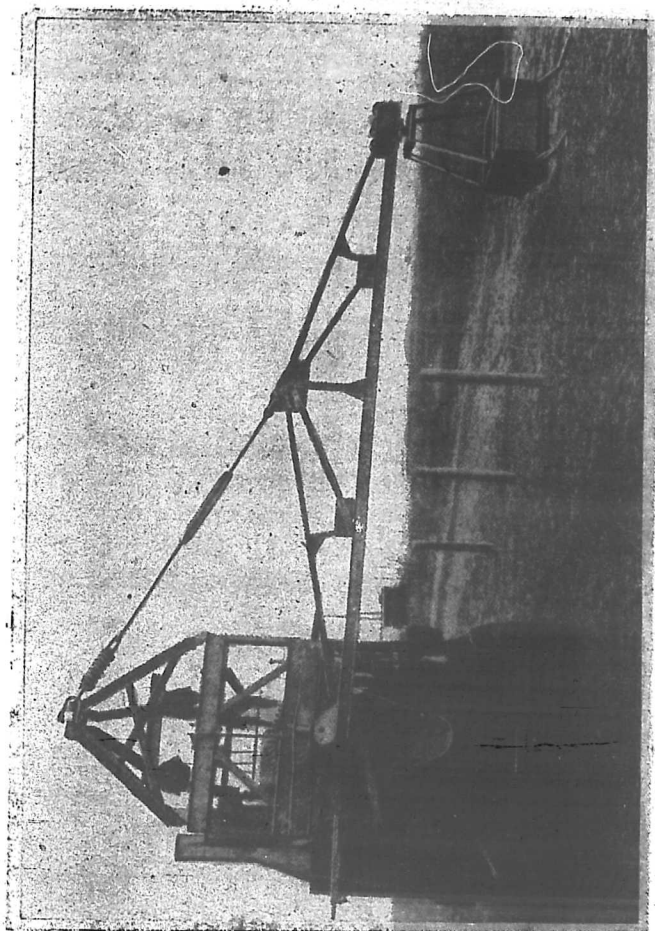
特製街道工程運送混凝土攪和機之後視圖附骨架
